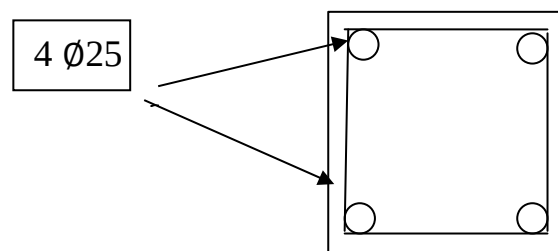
Ferrailage du poteau en traction selon l'EUROCODE
